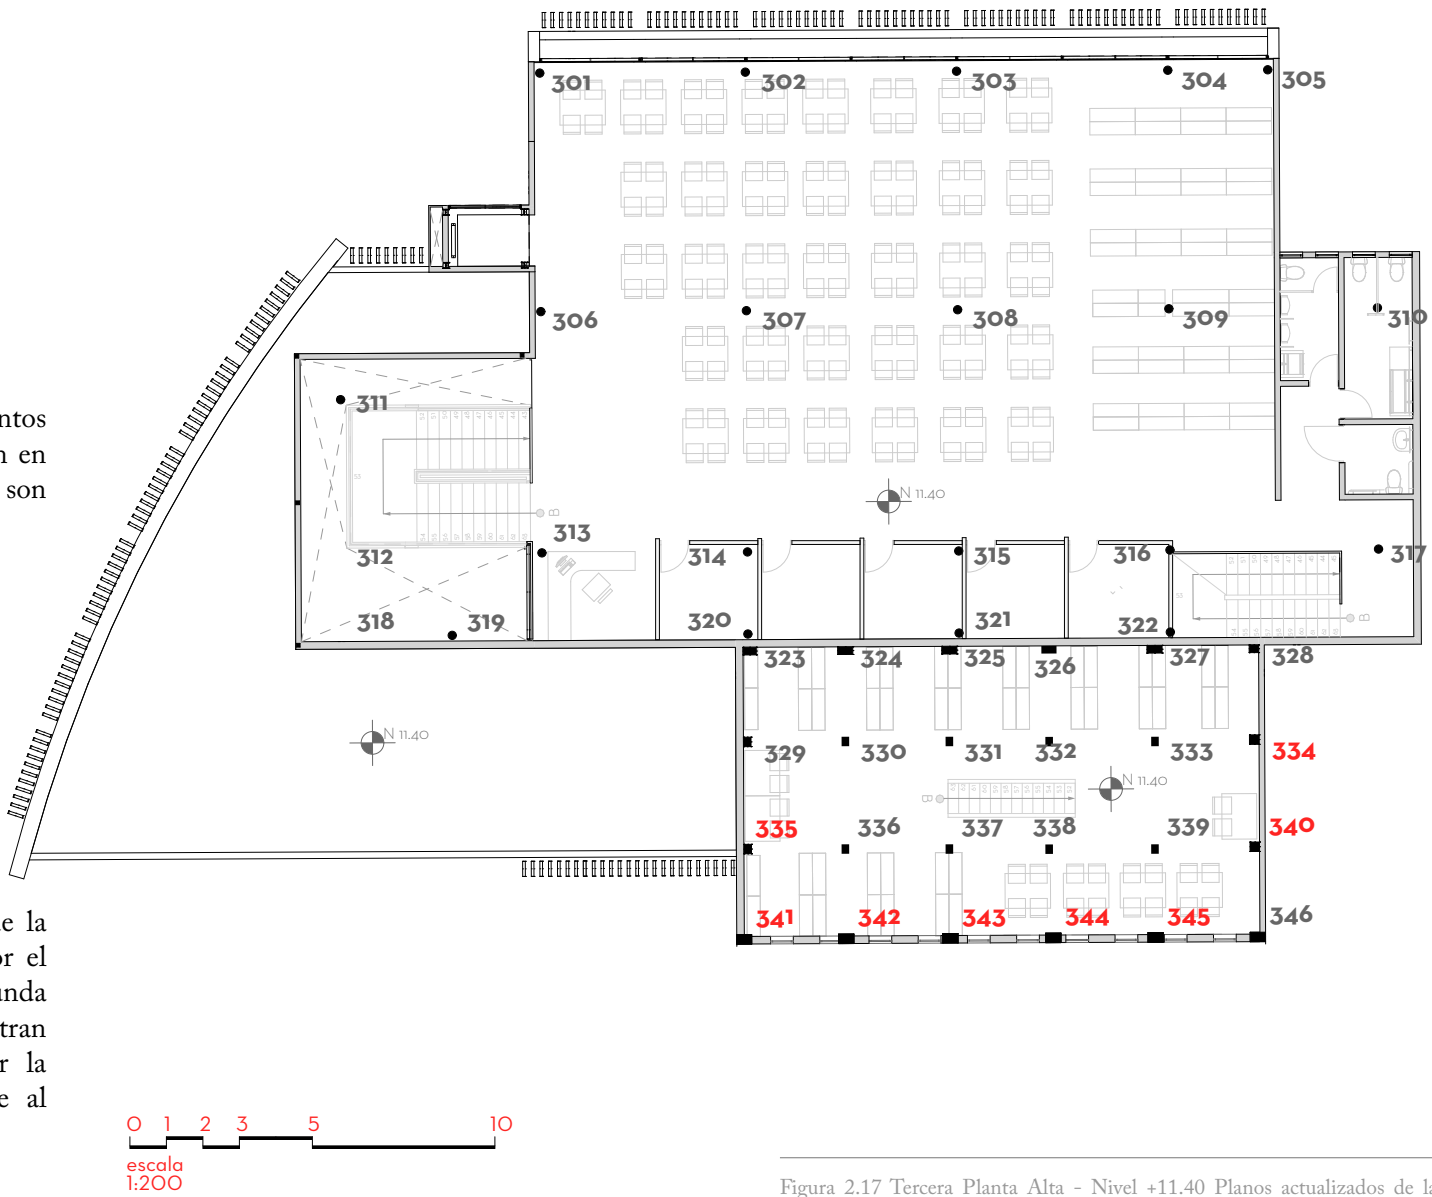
Tercera Planta Alta - Nivel +11.40 Planos actualizados de la edificación del Centro de Documentación Regional Juan Bautista Vásquez. Levantamiento arquitectónico y digitalización realizada por Morocho & Sarmiento (2020).
